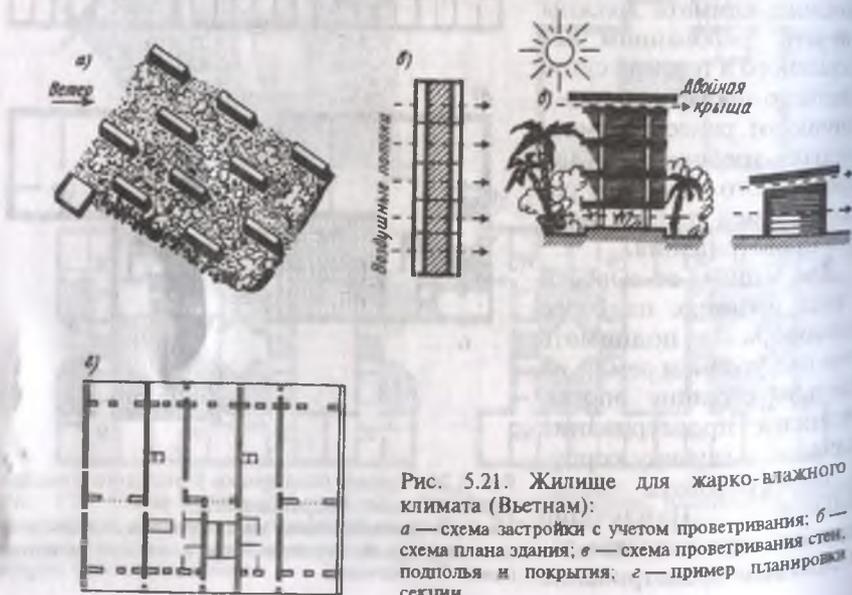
Жилище для жарко-влажного климата (Вьетнам): а — схема застройки с учетом проветривания; б — схема плана здания; в — схема проветривания стен, подполья и покрытия; г — пример планировки секции
